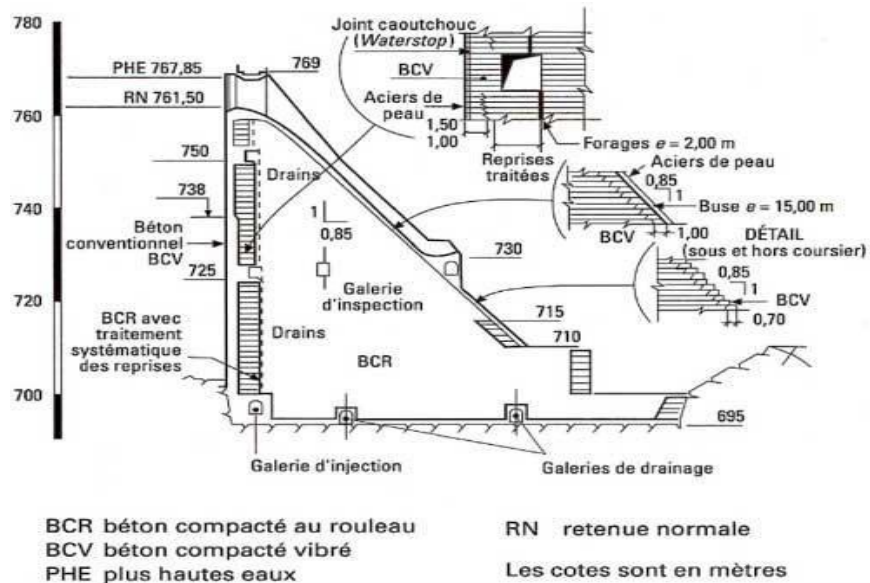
Barrage poids BCR d'Aoulouz (Maroc)
